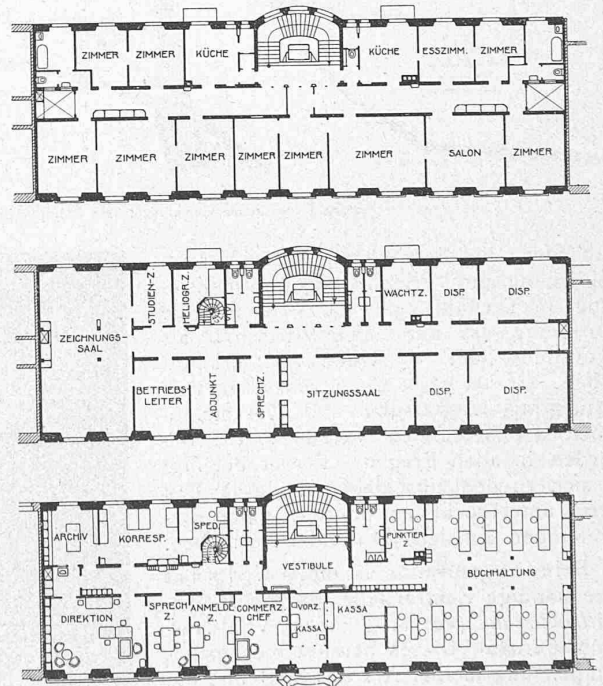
bis 4. Grundrisse der Obergeschosse. — Masstab 1 : 500.
